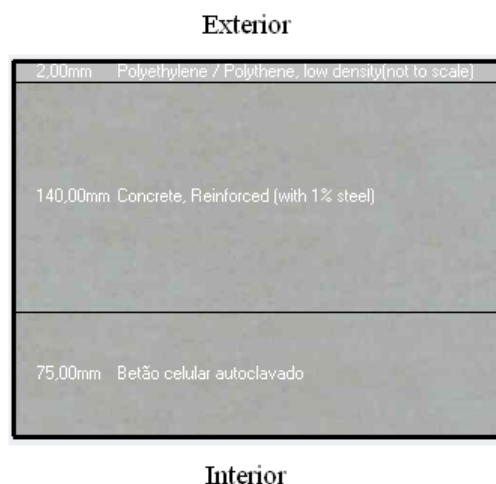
Estratificação da cobertura (Design Builder Software 2009).
